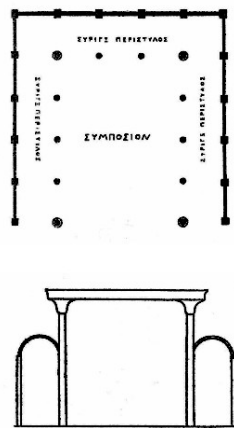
Ricostruzione secondo LEROUX 1913, figg. 62-63, pp. 226-227. La pianta e la sezione dell'alzato sono state montate in modo che le colonne dell'alzato corrispondano a quelle in pianta.
